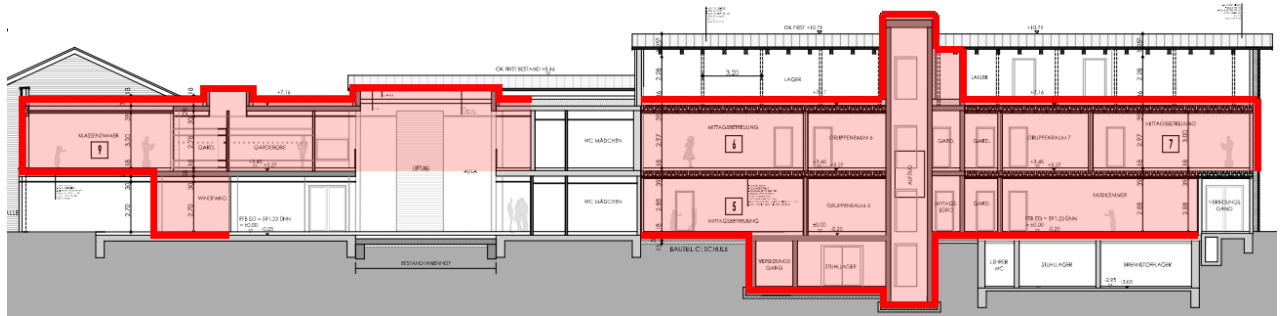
Gebäudelängsschnitt mit Verlauf der thermischen Hüllfläche der Erweiterung. Quelle: Planung Farthofer Architekt, mit Ergänzungen seitens LP
